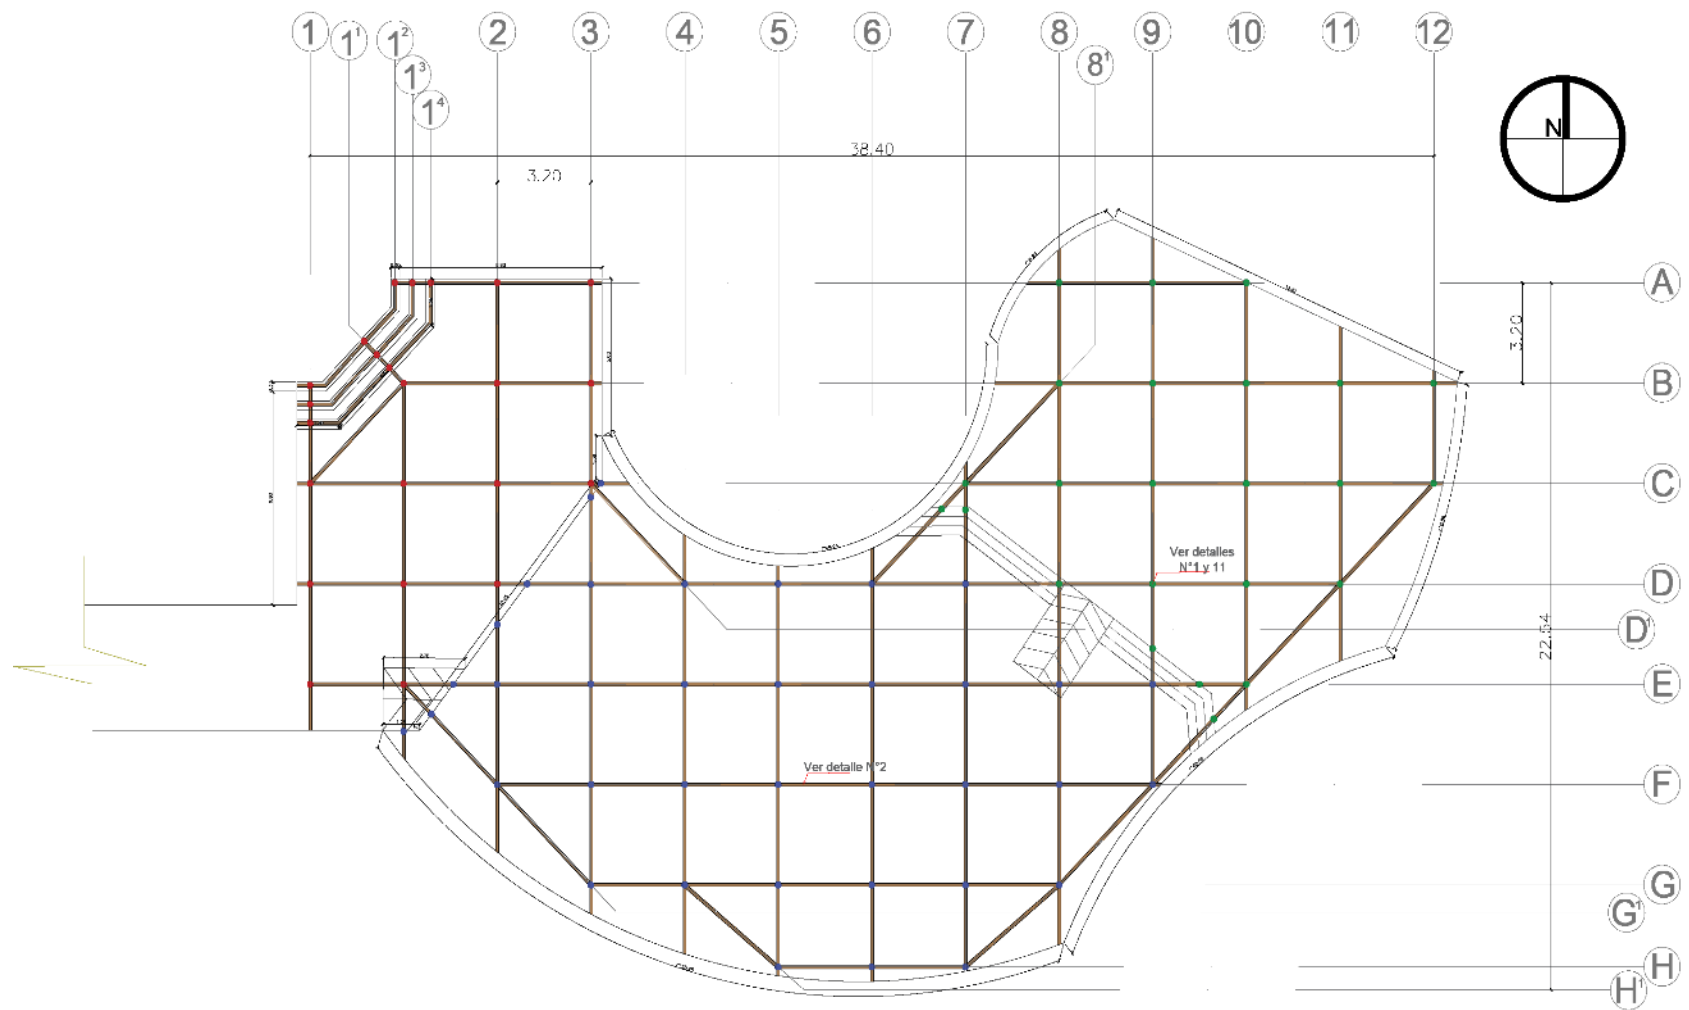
Planta estructural Parque y mirador. Fuente: Elaboración propia.
